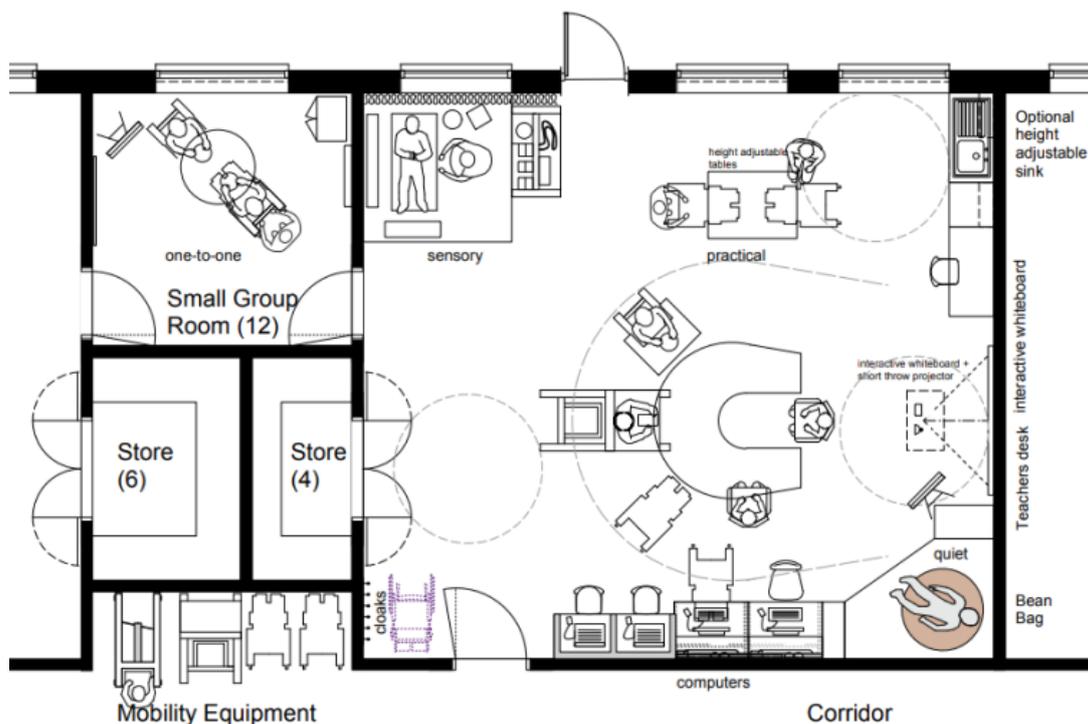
План группы помещений для детей с различными видами ОВЗ [2]
